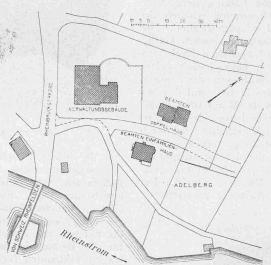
Lageplan der Baugruppe. — Masstab 1:2000.
